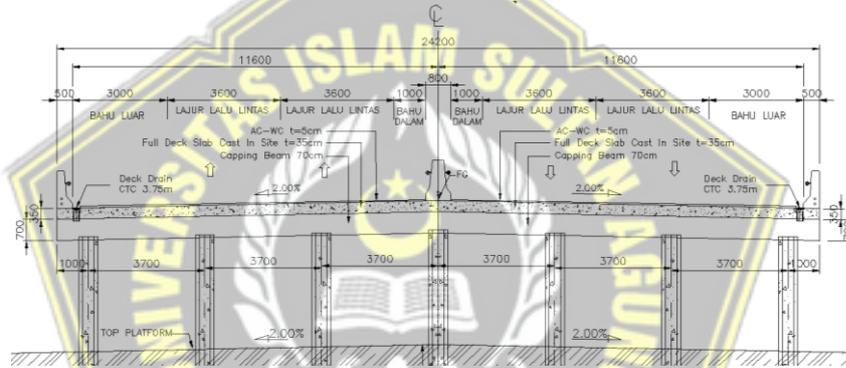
Cek Elevasi *Fullslab Precast
